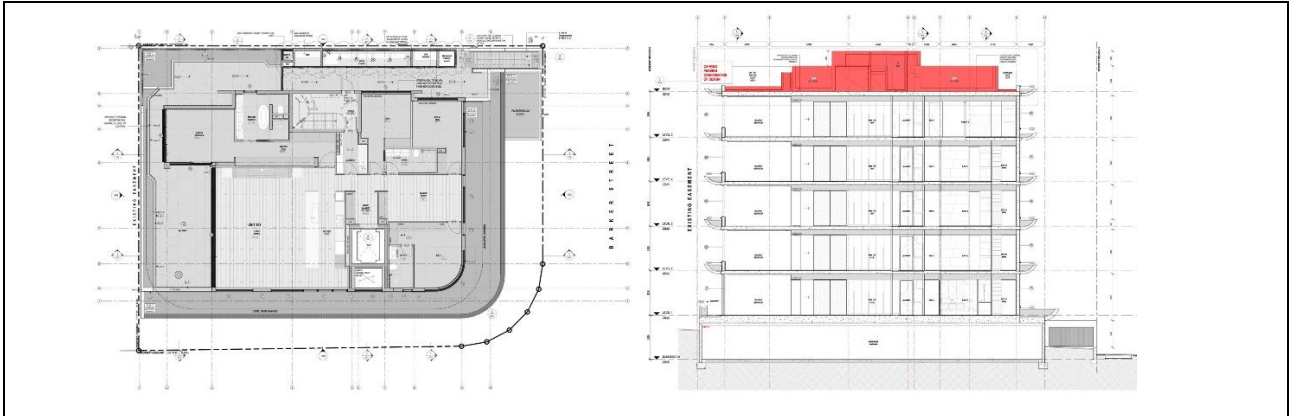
та рис.1.54. Maison New Farm Multi-residential Complex, планування першого поверху та розріз будівлі [36]
